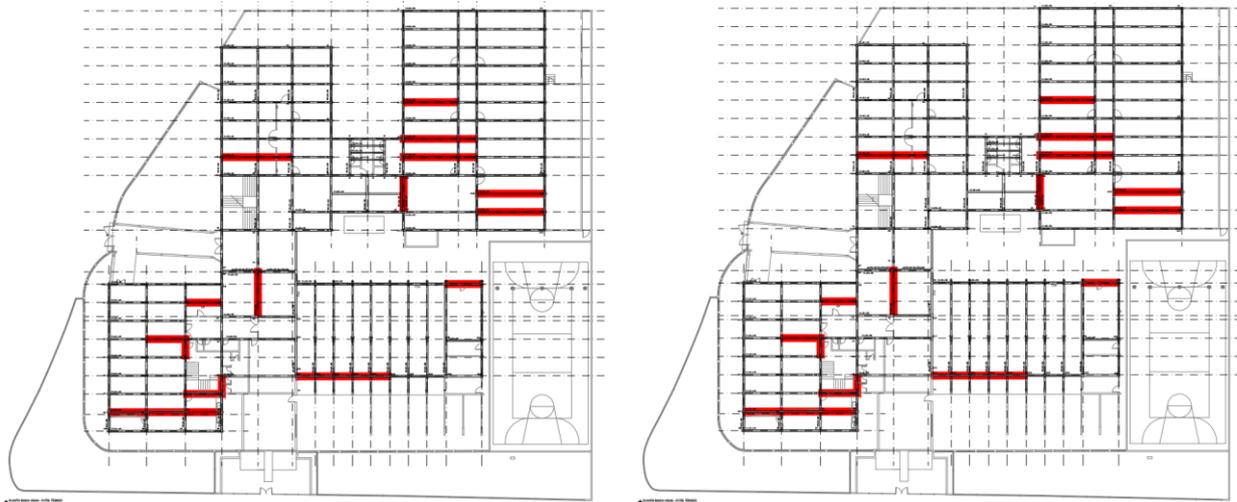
Vigas com armaduras expostas no pavimento térreo e superior (direita)
